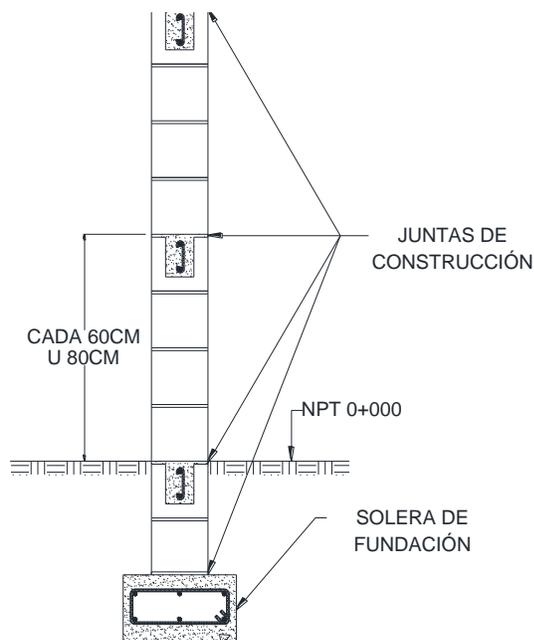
Esquema de juntas de construcción en paredes de bloque de concreto
